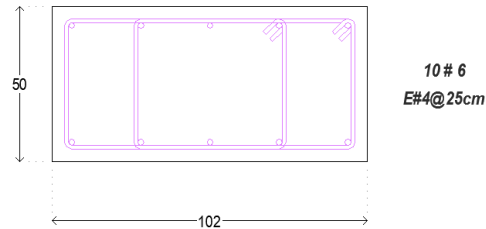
Arreglo de acero de columna C-2 para cimentación de turbogenerador
